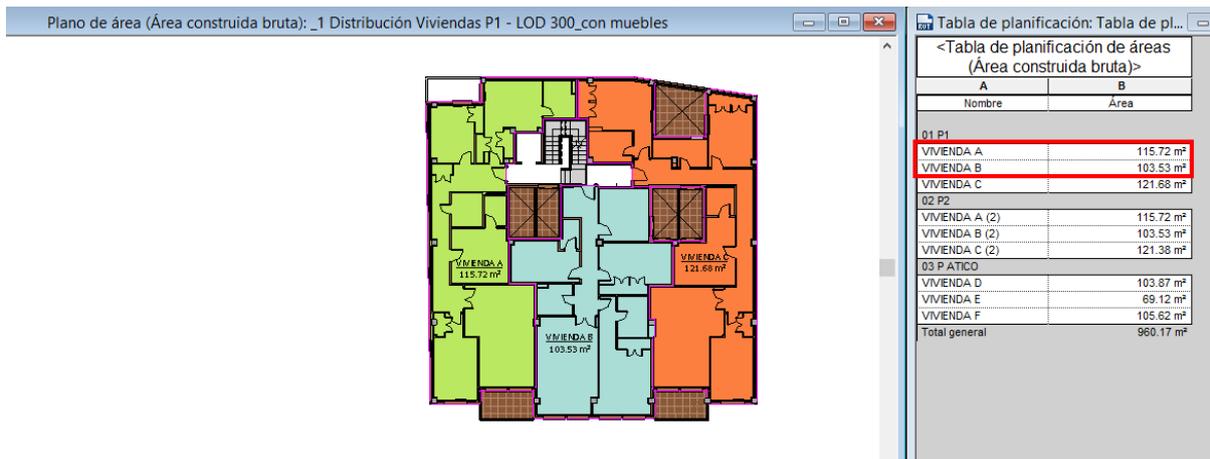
Plano de Área construida bruta Planta Tipo y Tabla de Planificación, 2014.
